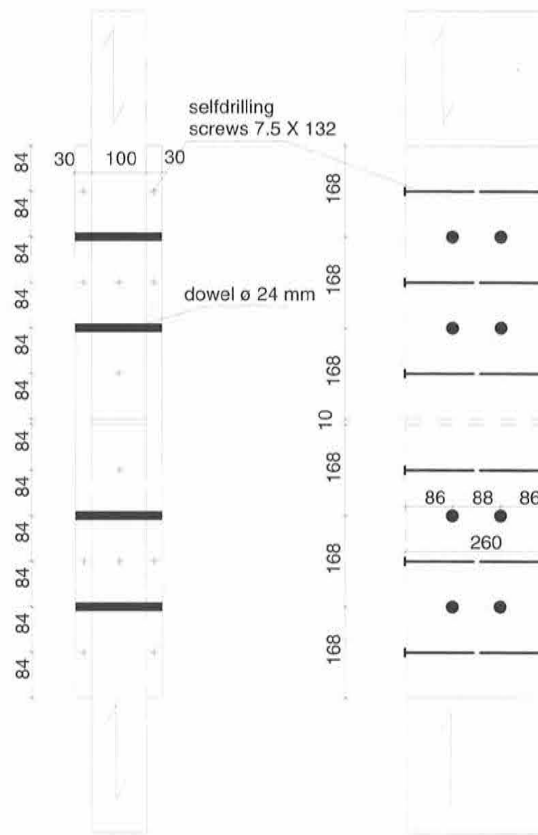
Prüfkörper mit Querkzugverstärkung durch Vollgewindeschrauben
